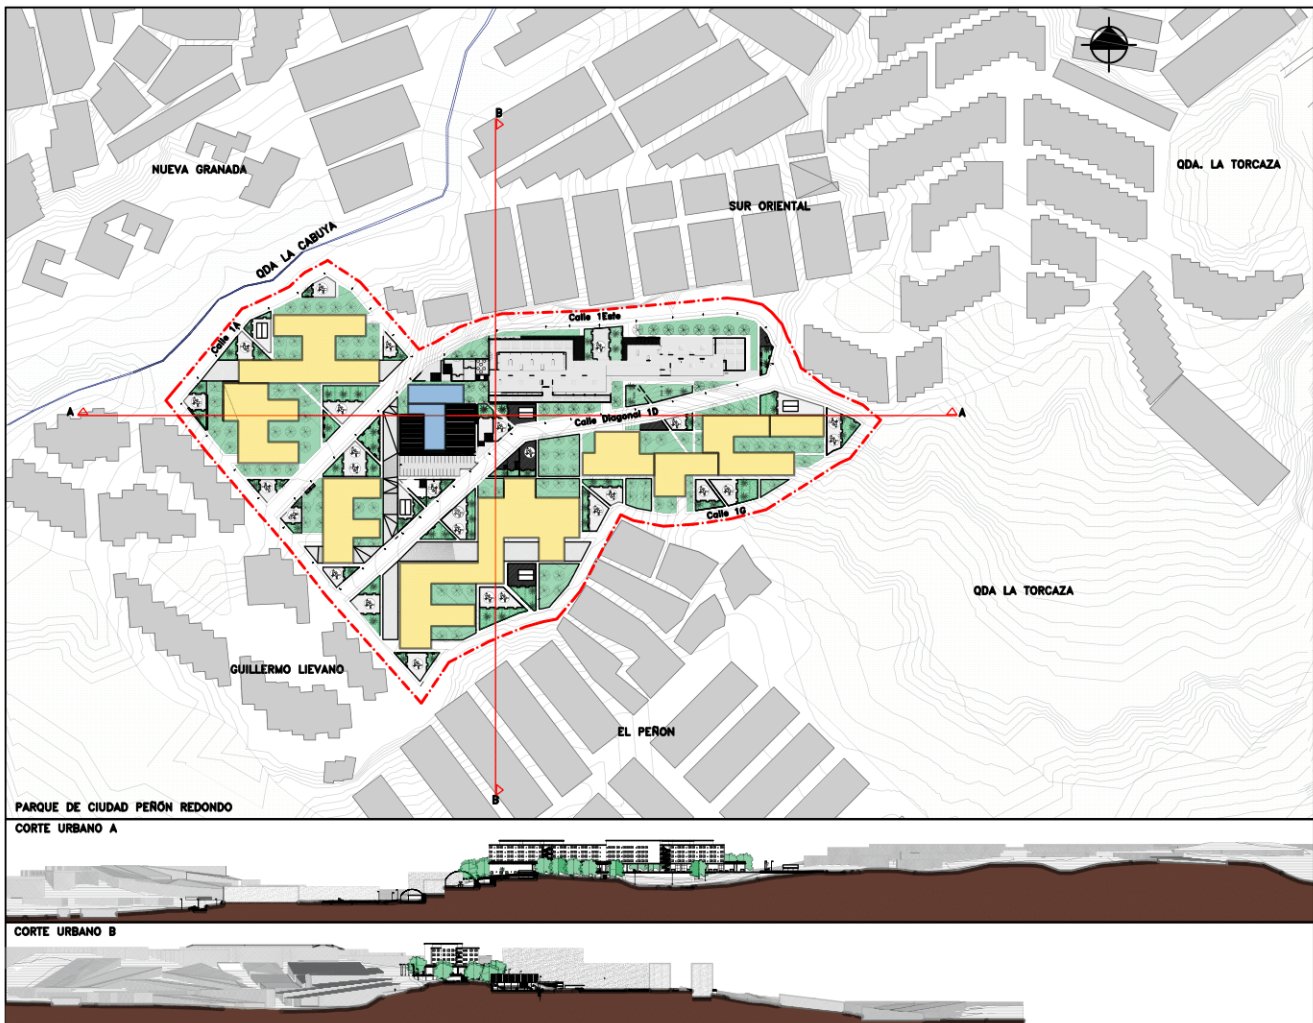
Plano de planta con cortes urbanos escala 1:5000, Elaboración
